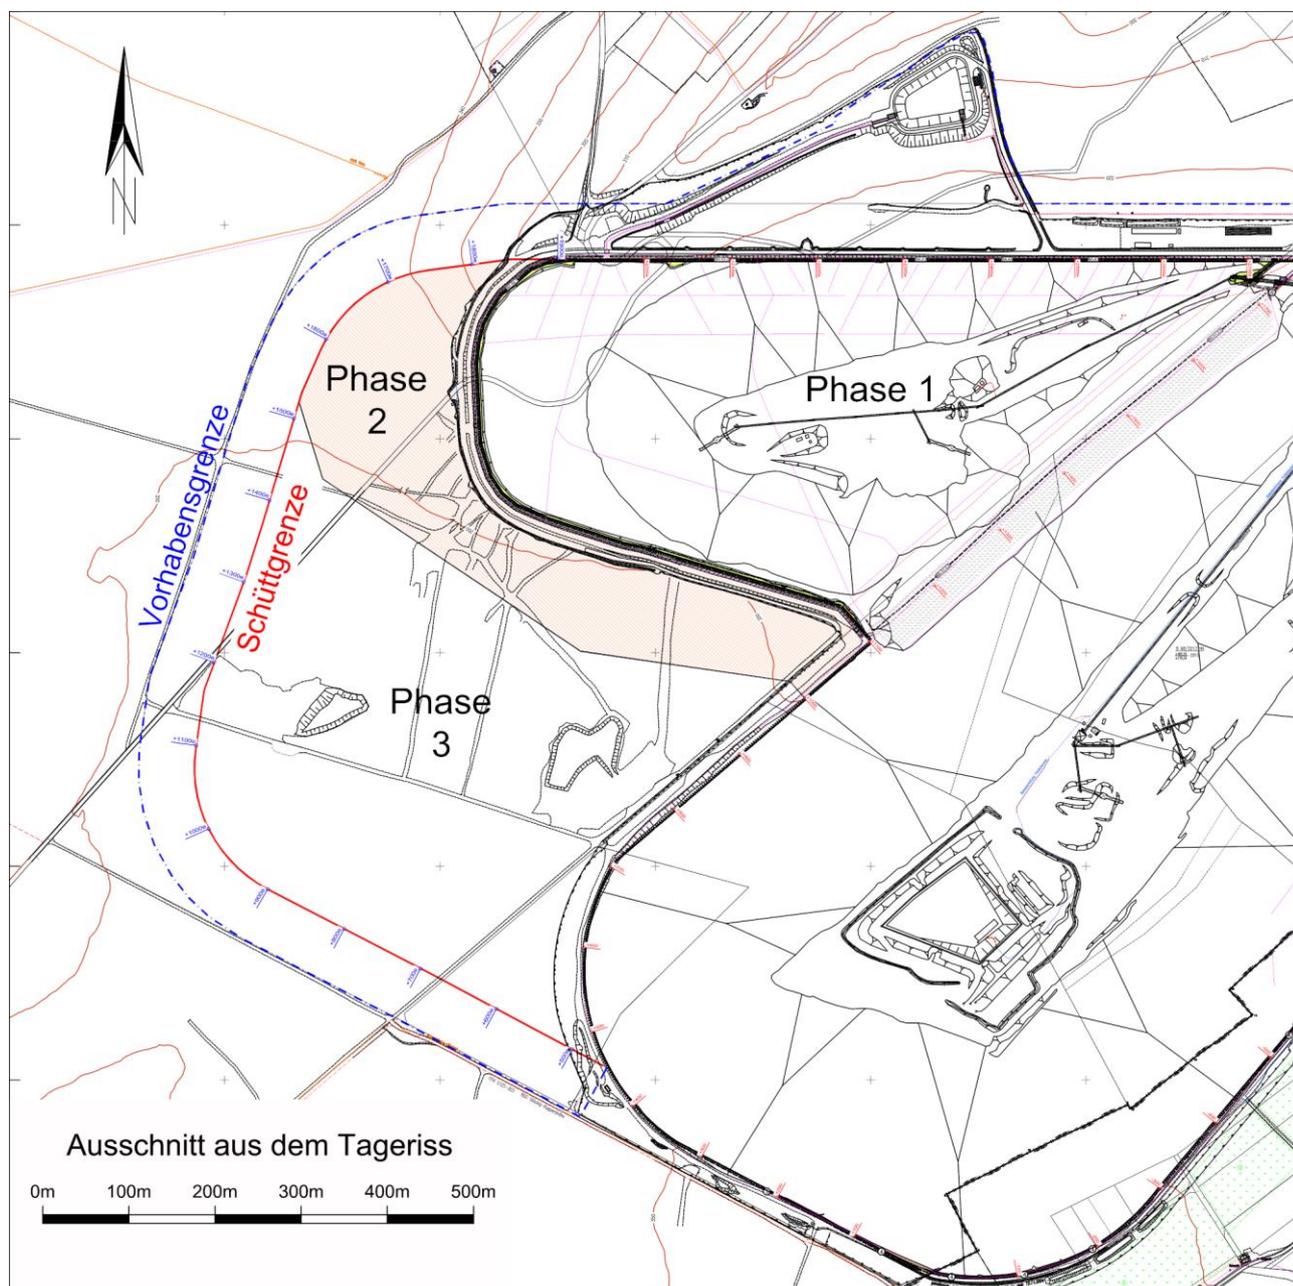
Grundfläche des zukünftigen Haldenkörpers (bestehende und geplante Haldenfläche)
